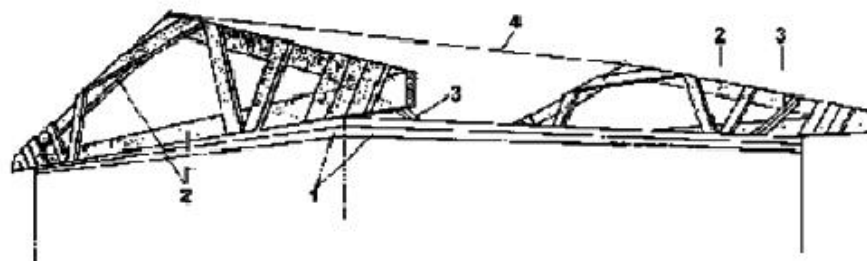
Установка маячных стропил 1 - верхняя обвязка стен; 2 - стропильная ферма; 3 - дощатая расшивка; 4 - маячный шнур
